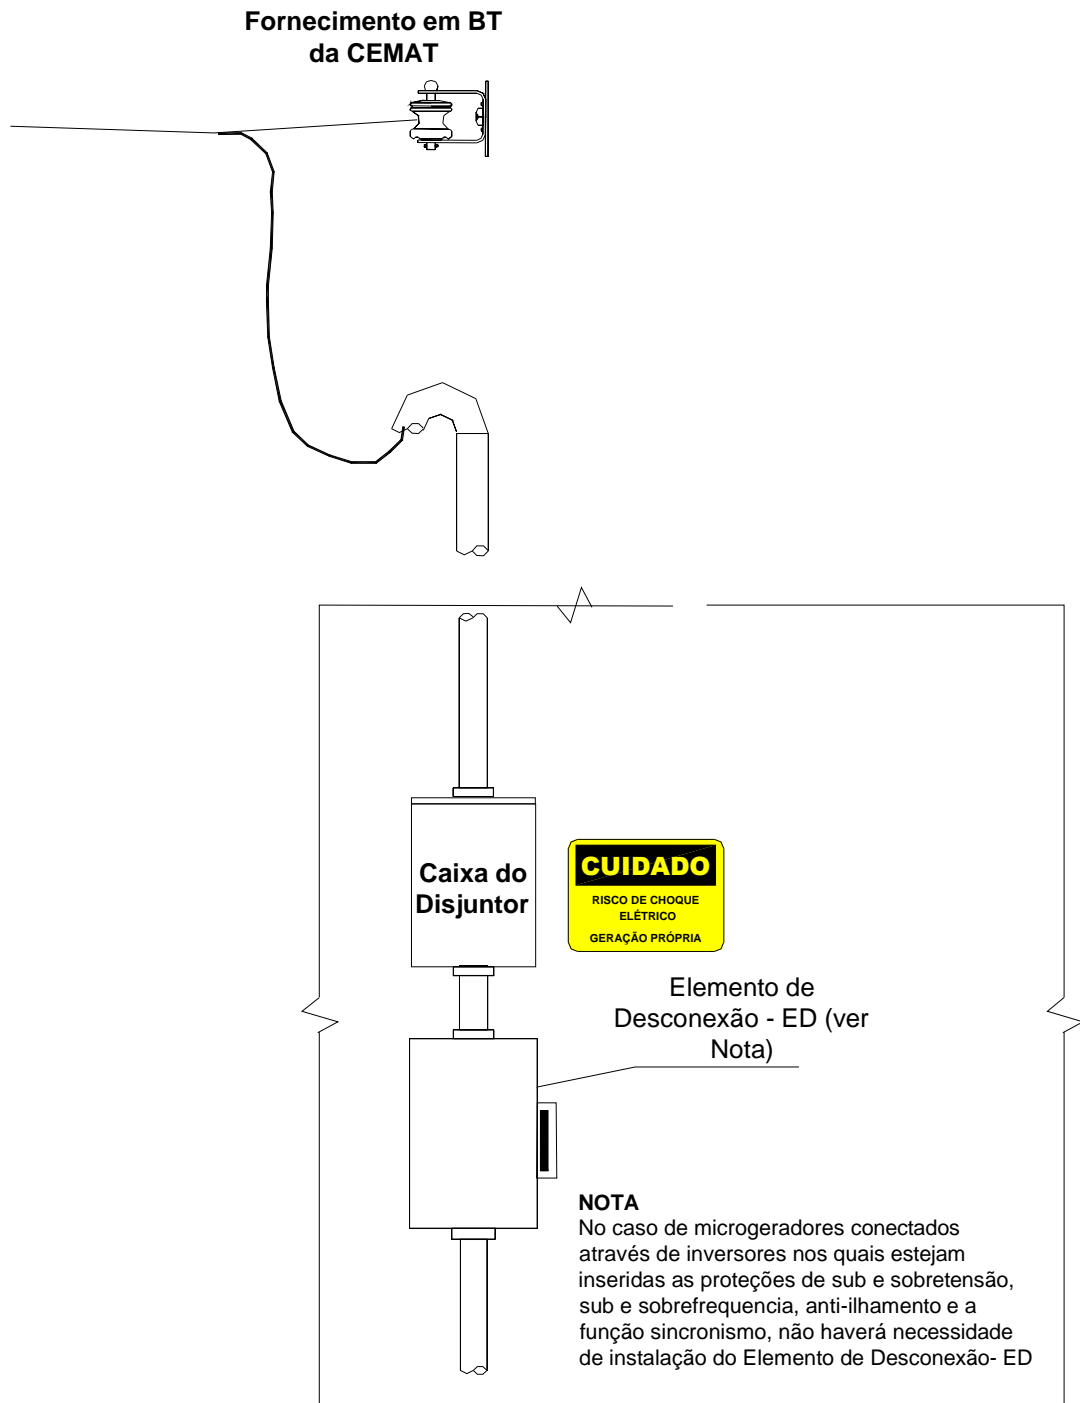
Disposição do Elemento de Desconexão - ED - instalado junto à proteção no padrão de entrada em muro ou mureta - com a medição externa no poste da RD
